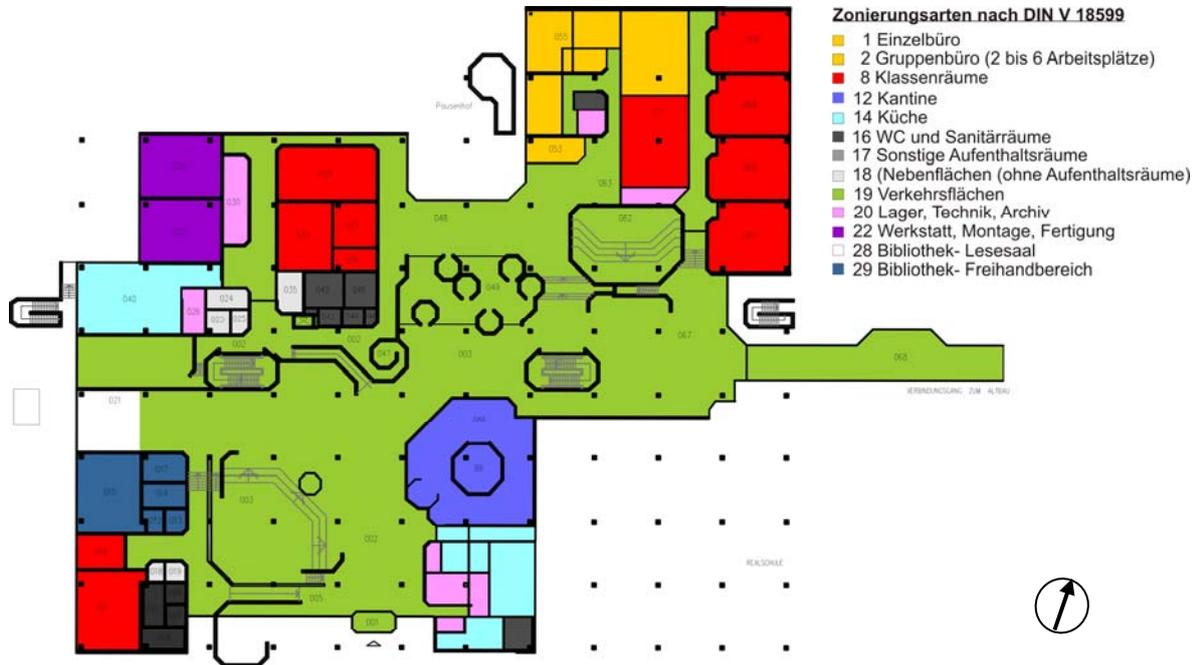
Haupt- und Realschule Grundriss EG Planung
